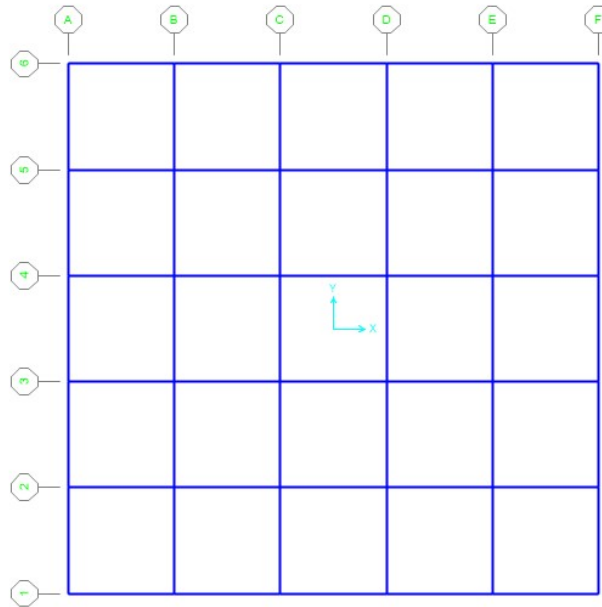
Vista en Planta de los pórticos / vista de la estructura en SAP 2000.
